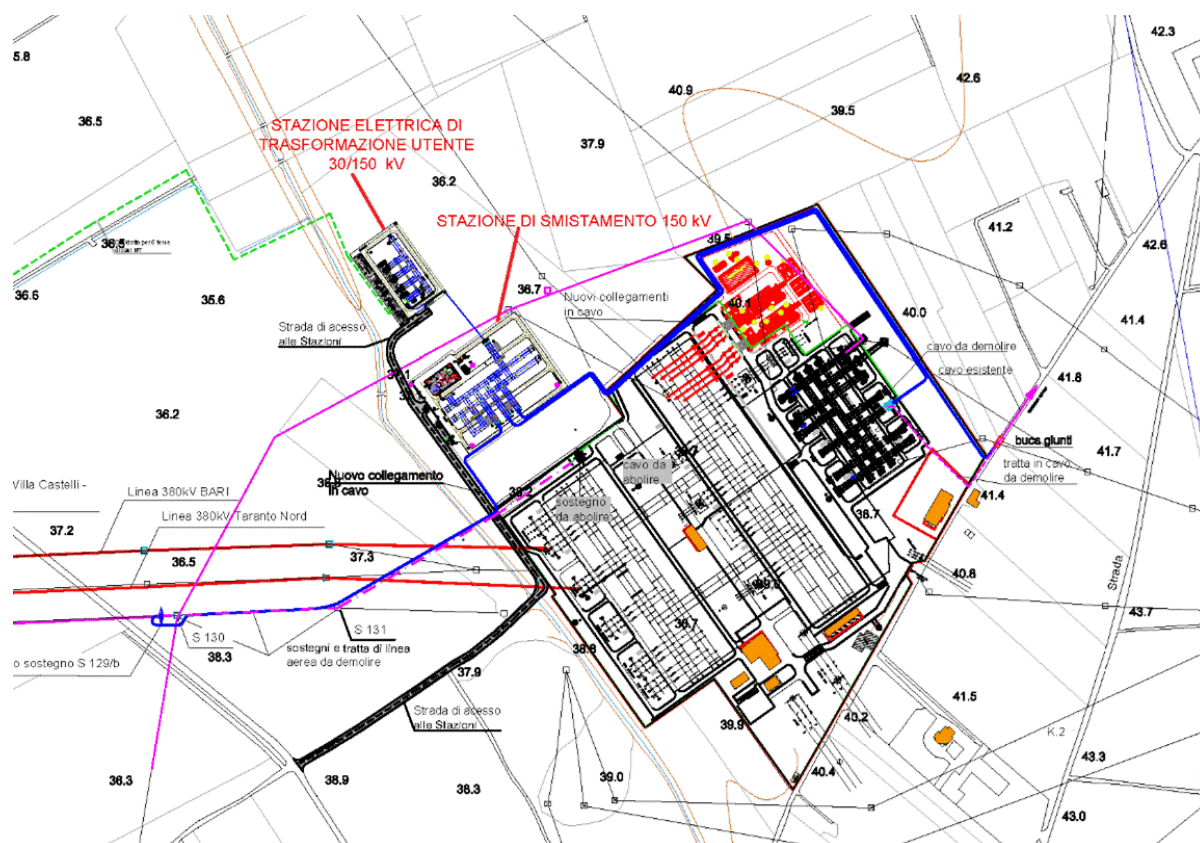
Stazione di elevazione MT/AT (a nord-ovest della stazione Terna), stazione di smistamento ed elettrodotto in MT da realizzare (linea verde tratteggiata) uscente dalla stazione di elevazione.
